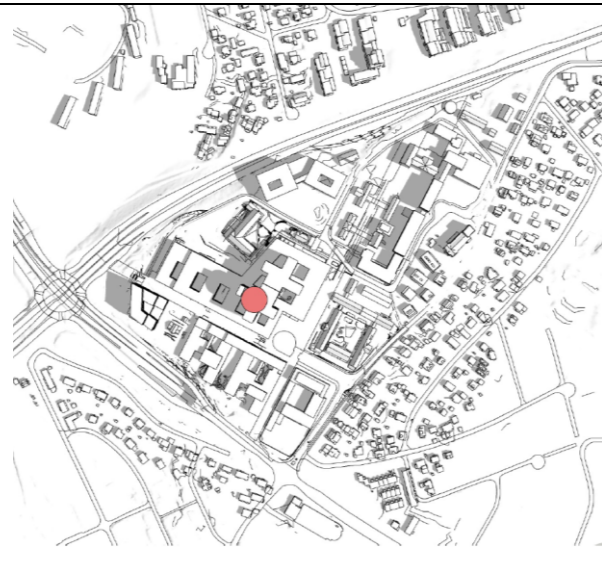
Planforslaget 1.5.2019 kl. 18.00.
